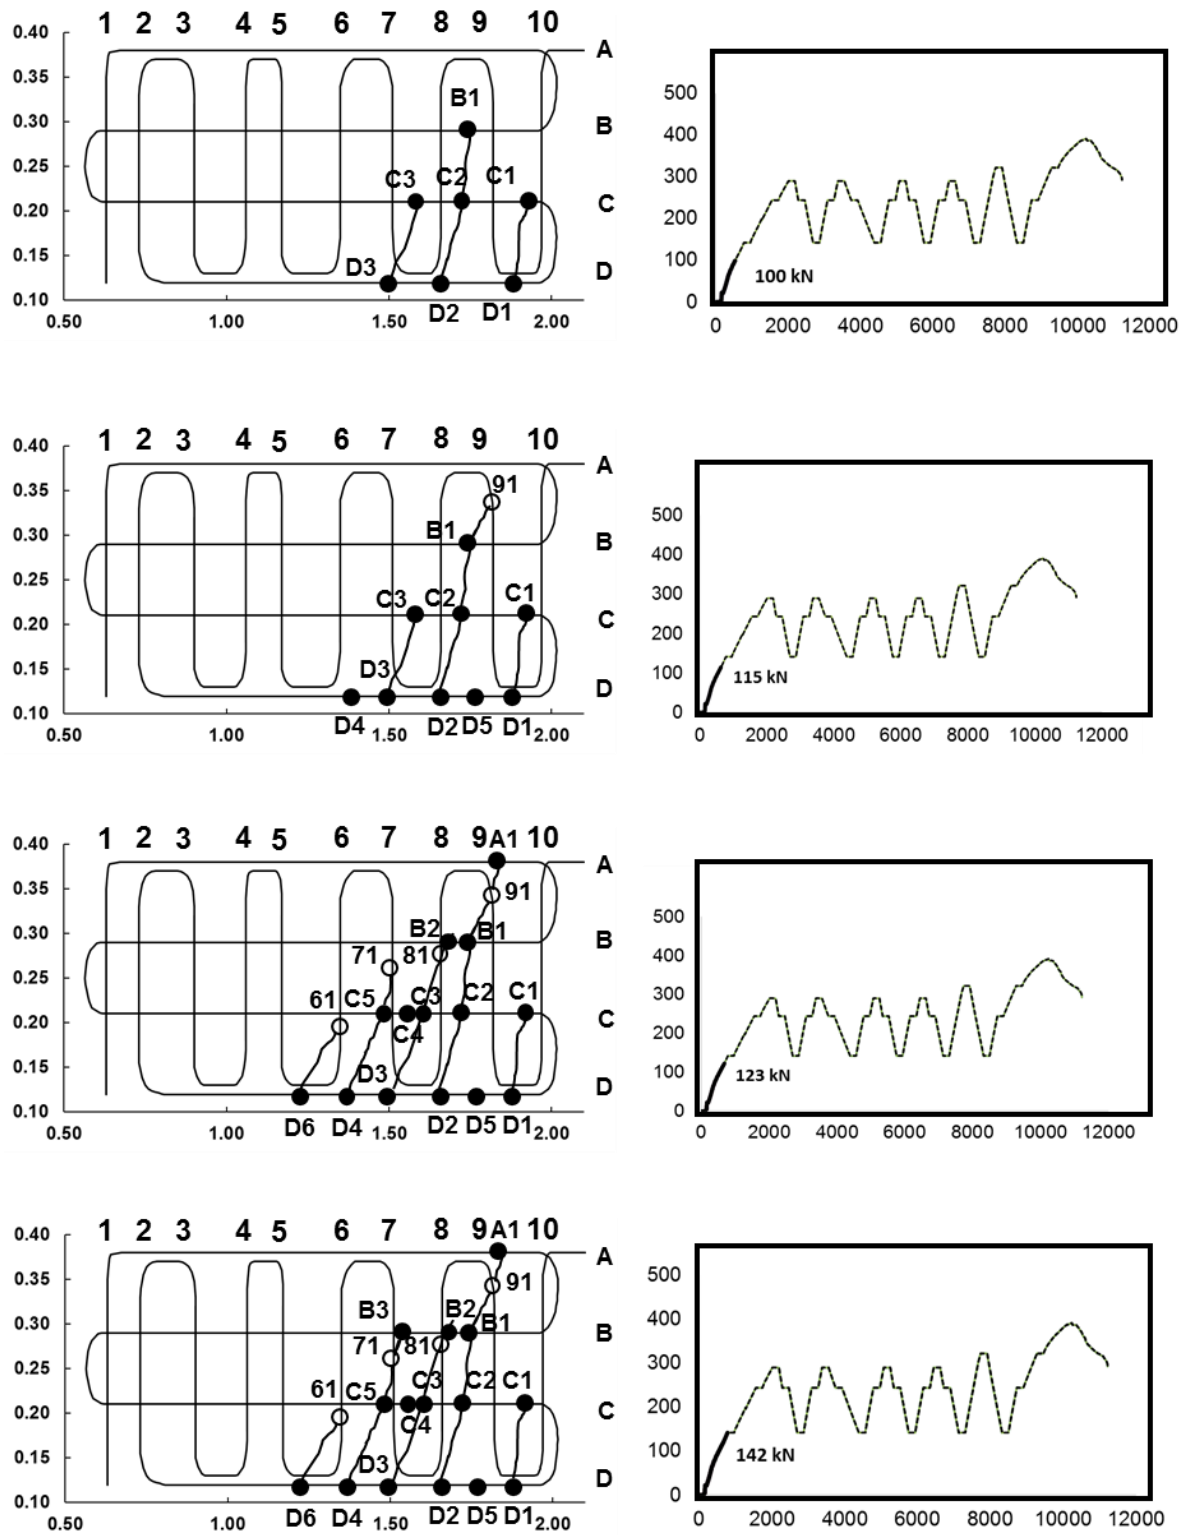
Patrones de fisuración de la viga I-2 (100 a 142 kN)
